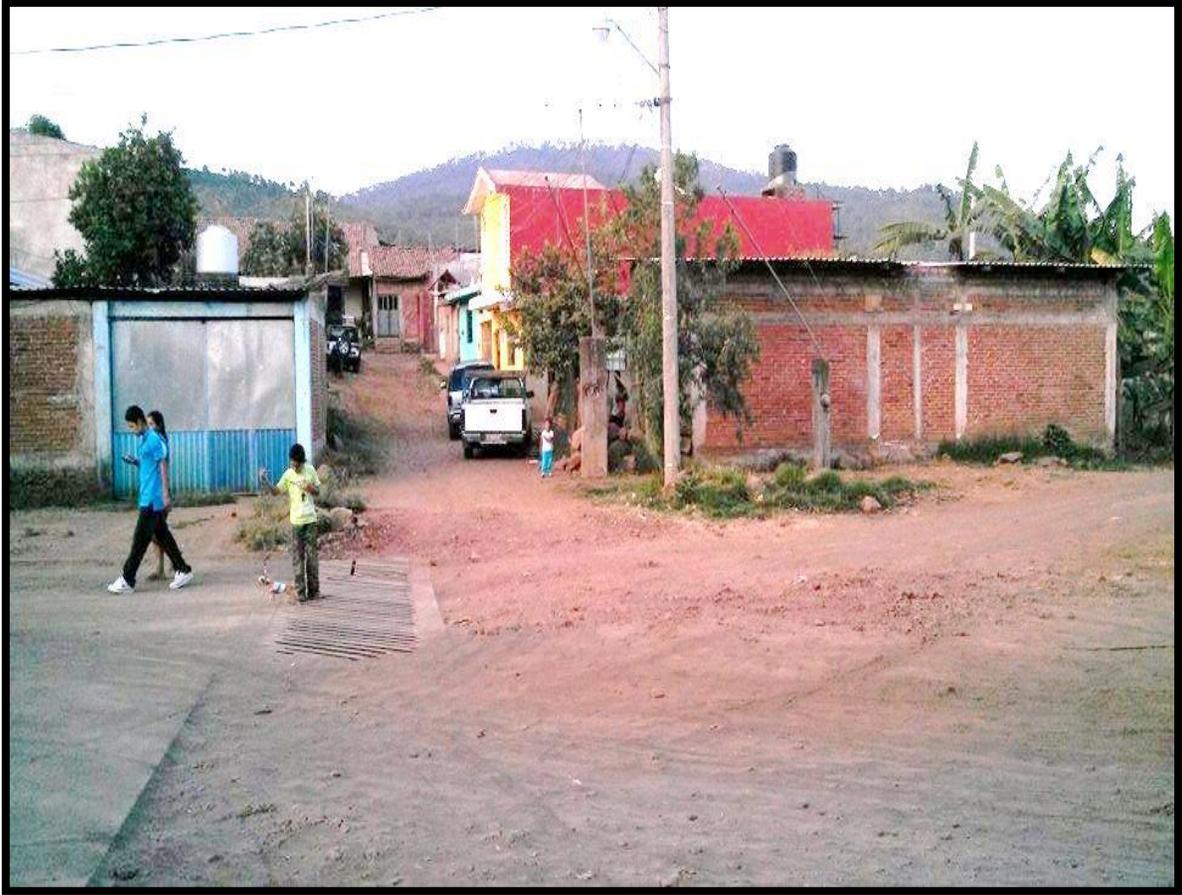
En esta imagen se aprecia una parte de calle que ya cuenta con pavimento de concreto hidráulico.
